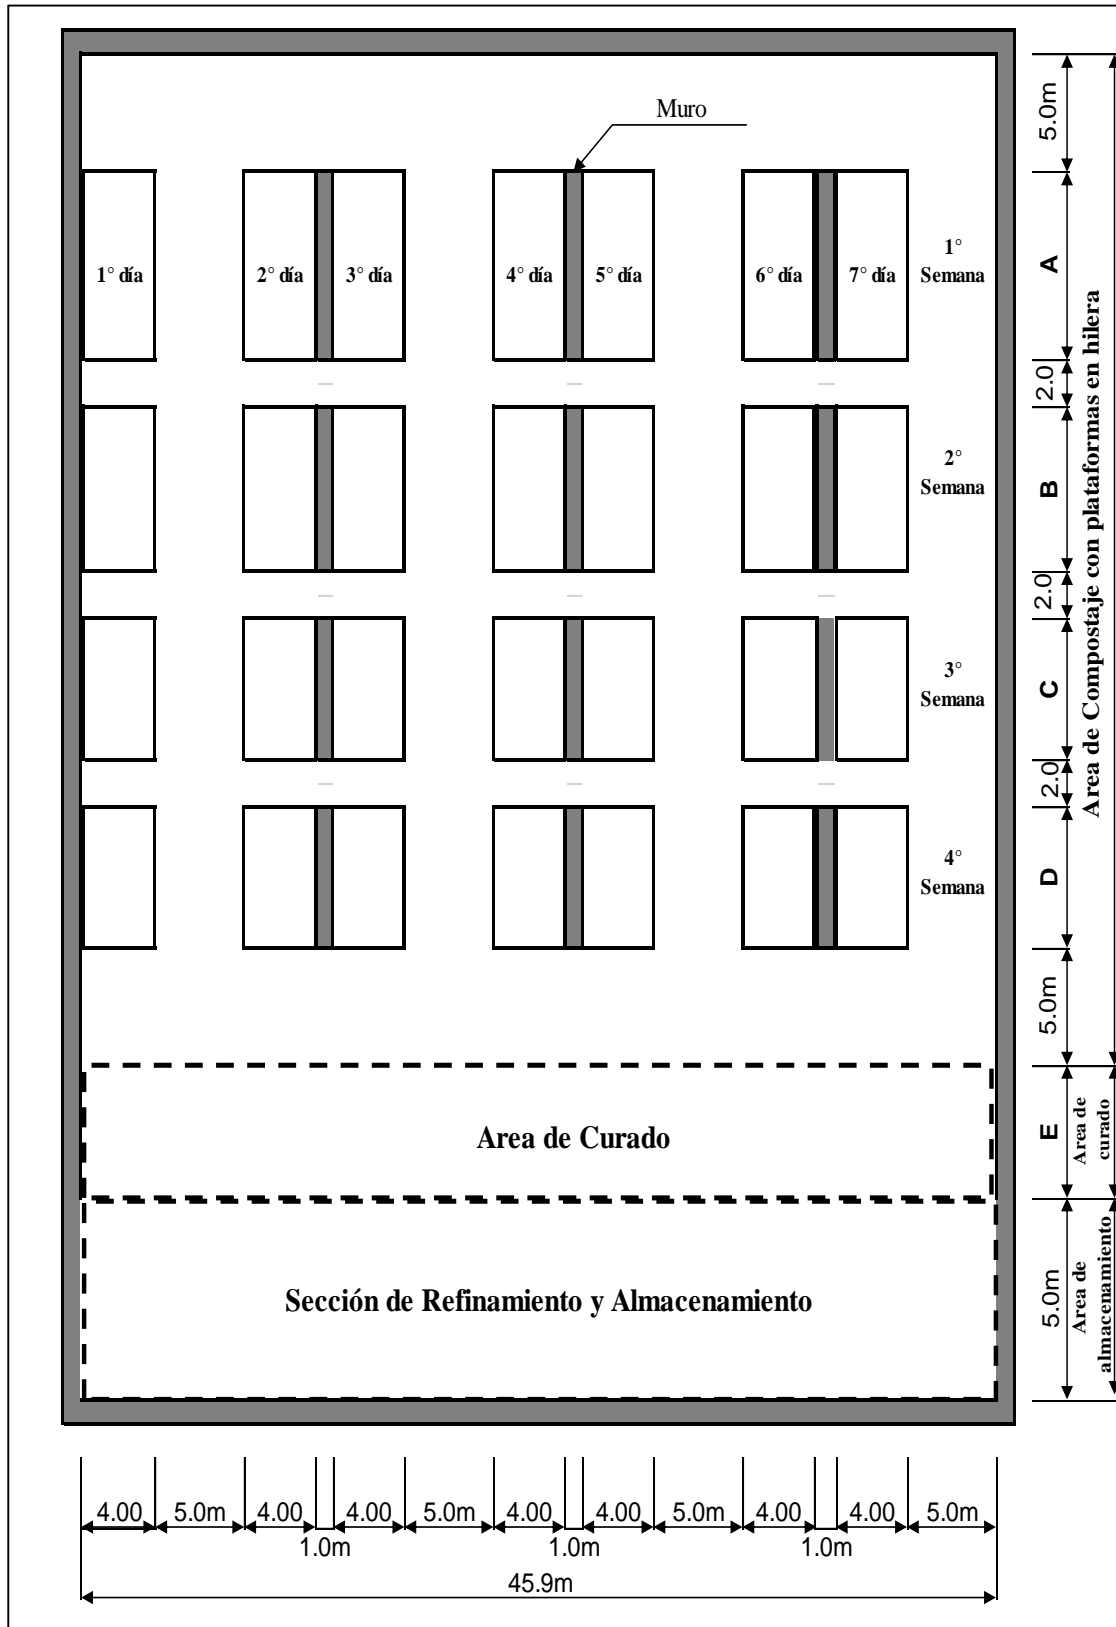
Diseño de la planta de compostaje. Elaboración propia.
